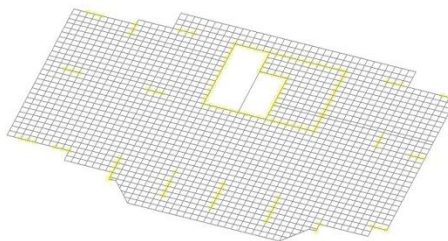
Розрахункова схема багатопорожнистої плити перекриття
